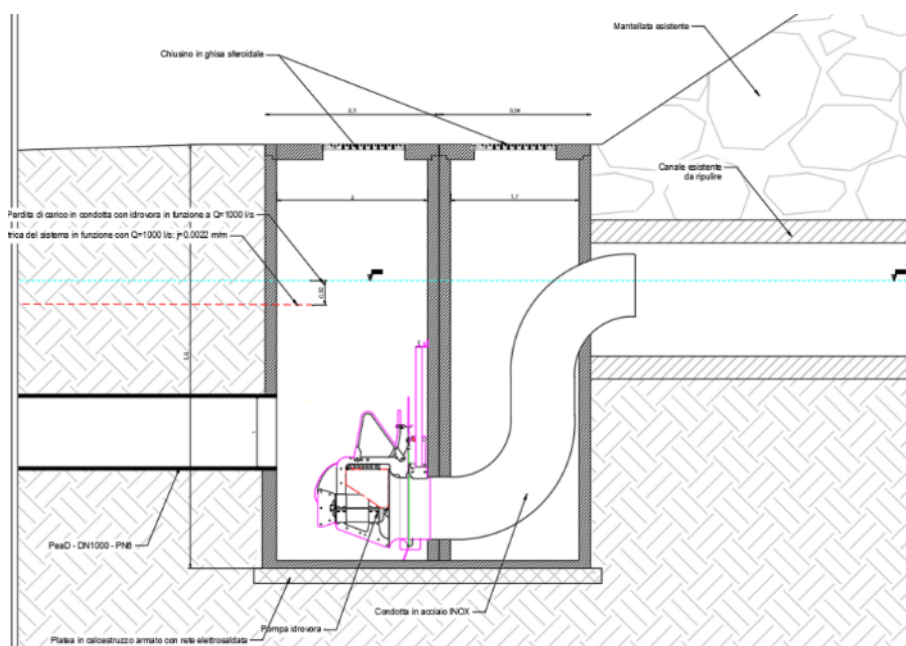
Pozzetti di ricircolo di progetto – sezione trasversale.
